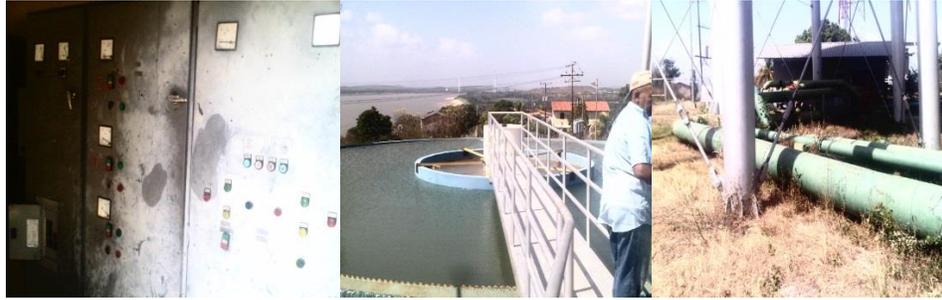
Generador eléctrico y sedimentador y tuberías la planta de tratamiento.
